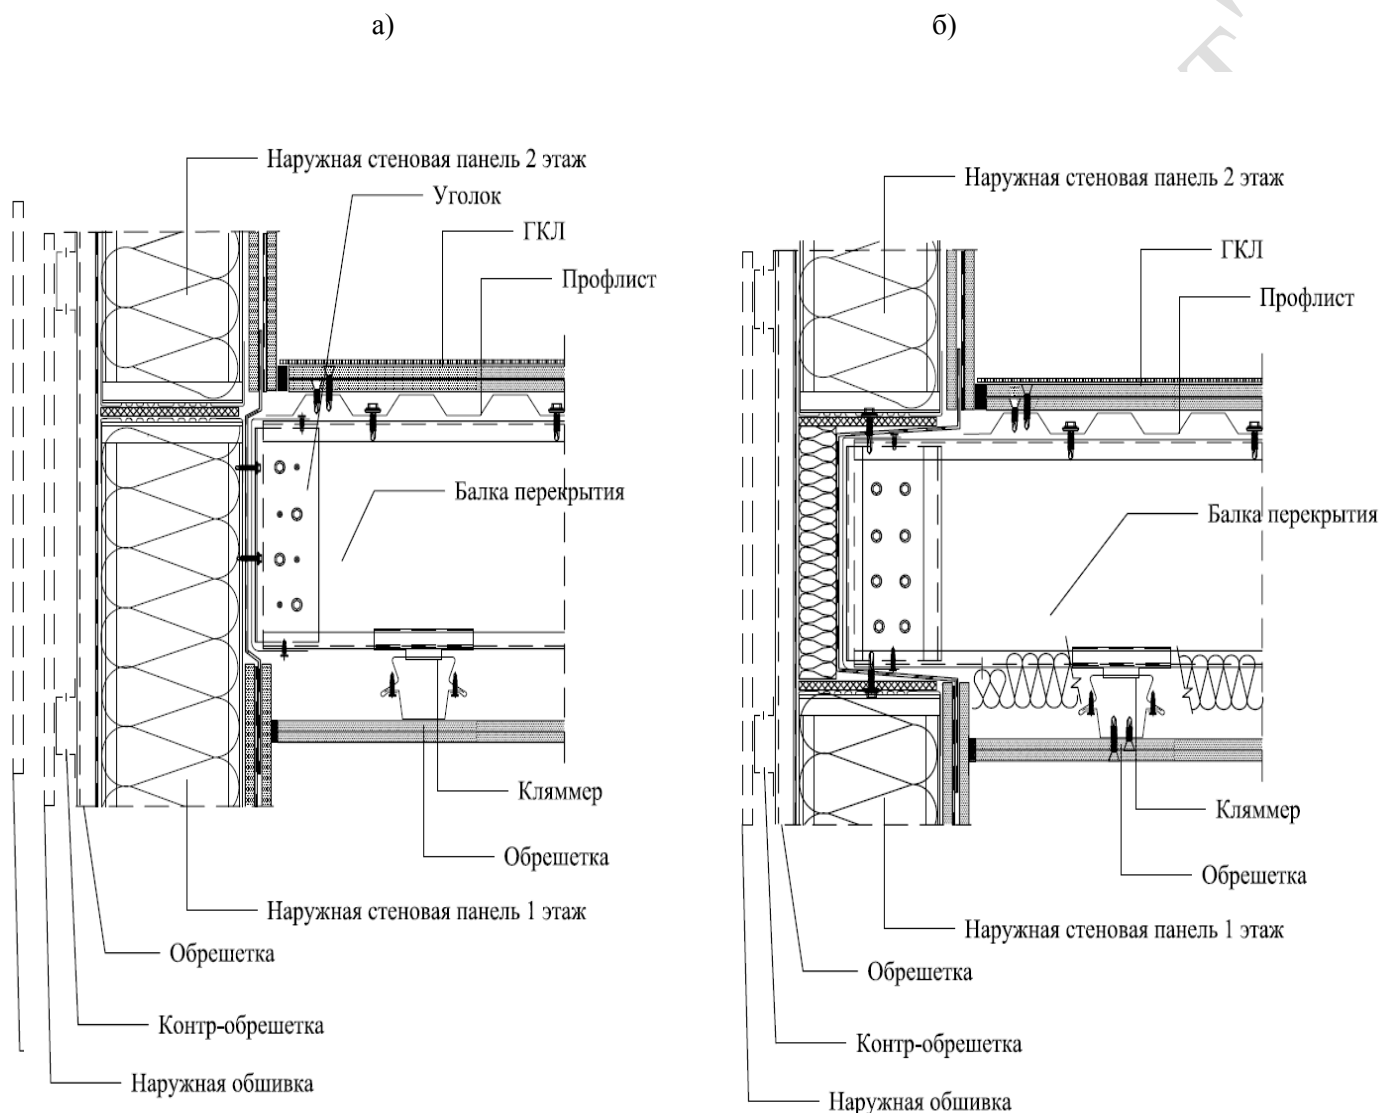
Узлы соединения междуэтажного перекрытия с наружной стеной:
